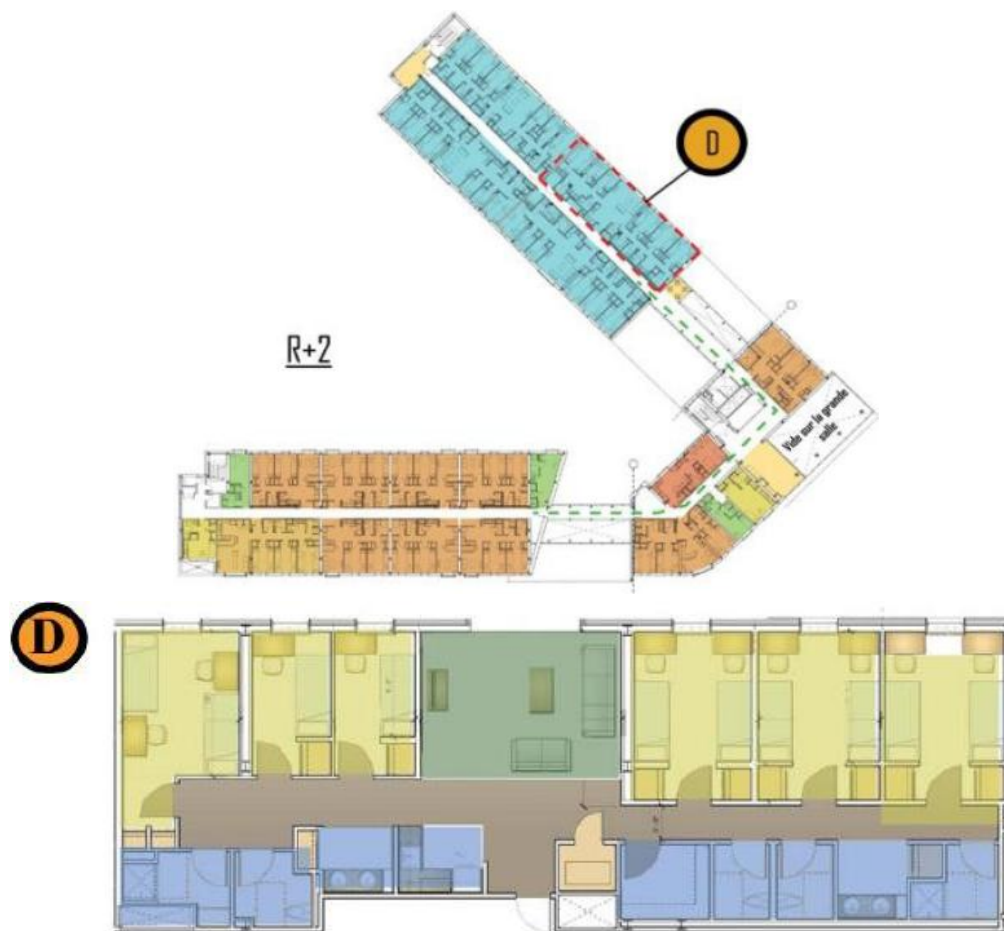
Plan 2^{ème} étage + la typologie D d’hébergement 29
